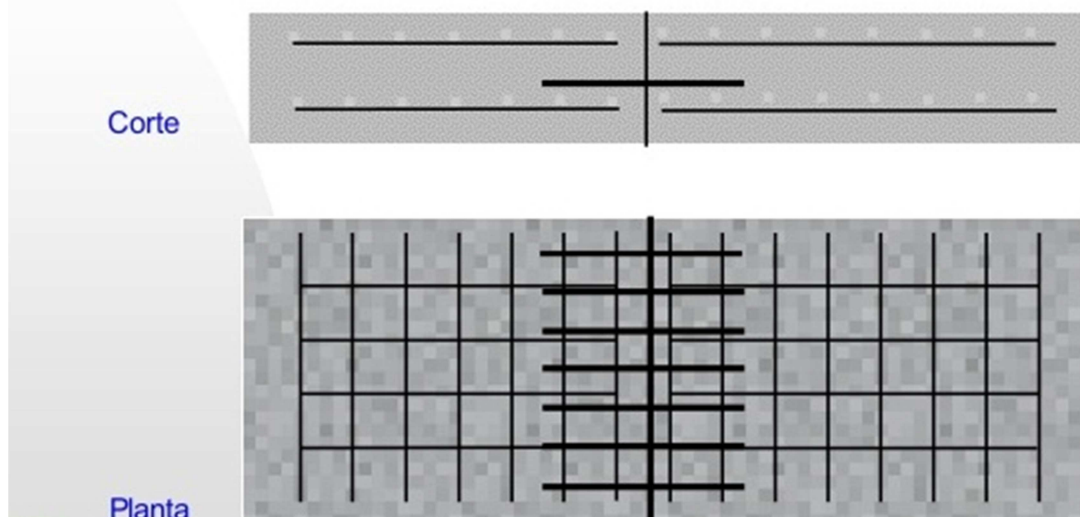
Pavimentos de Concreto Estruturalmente Armados
